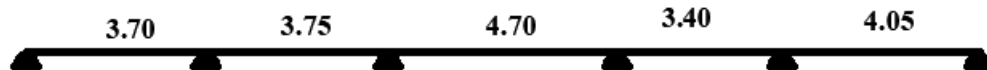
Schéma statique des poutrelles de plancher de terrasse
